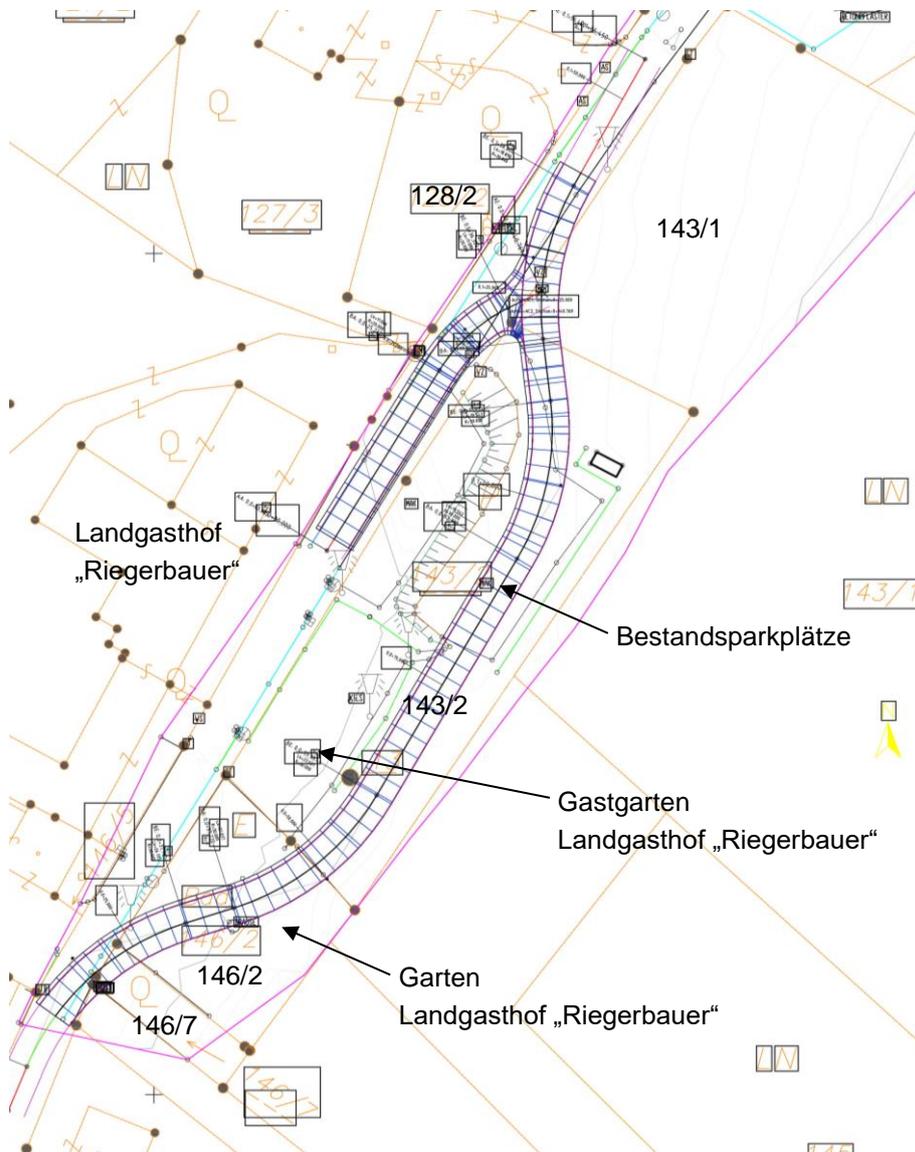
Grundriss Variante 2²²⁷
